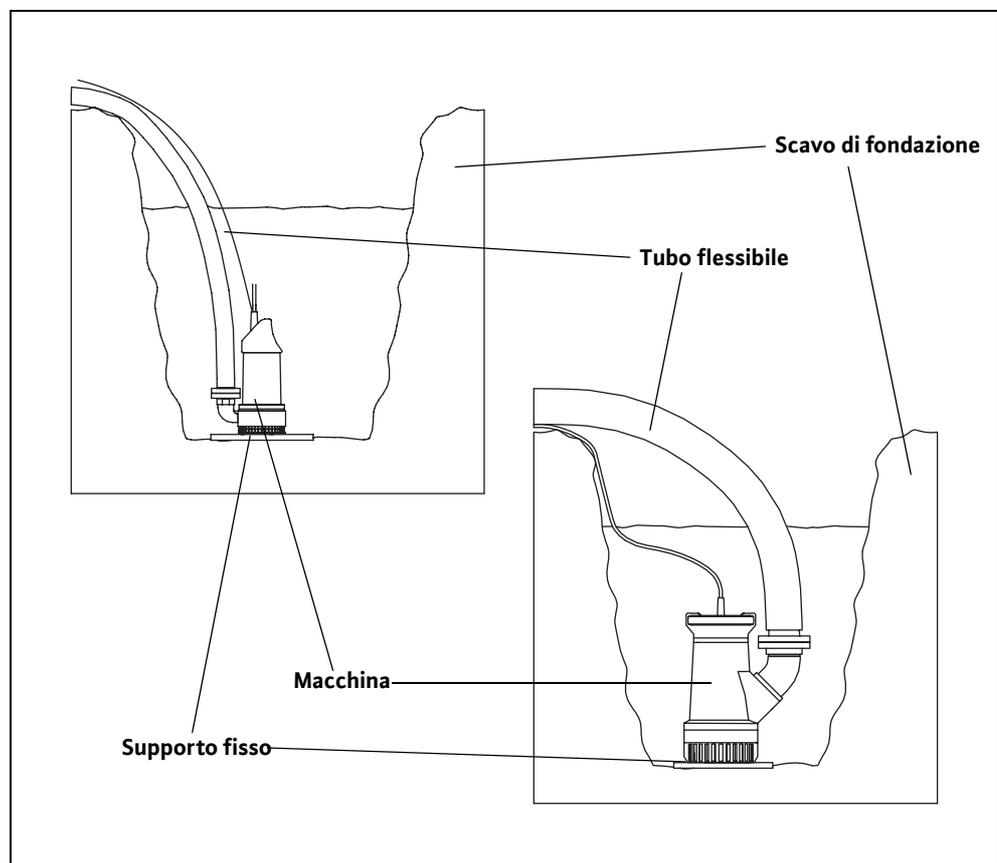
Montaggio indipendente con collegamento tramite tubo flessibile
